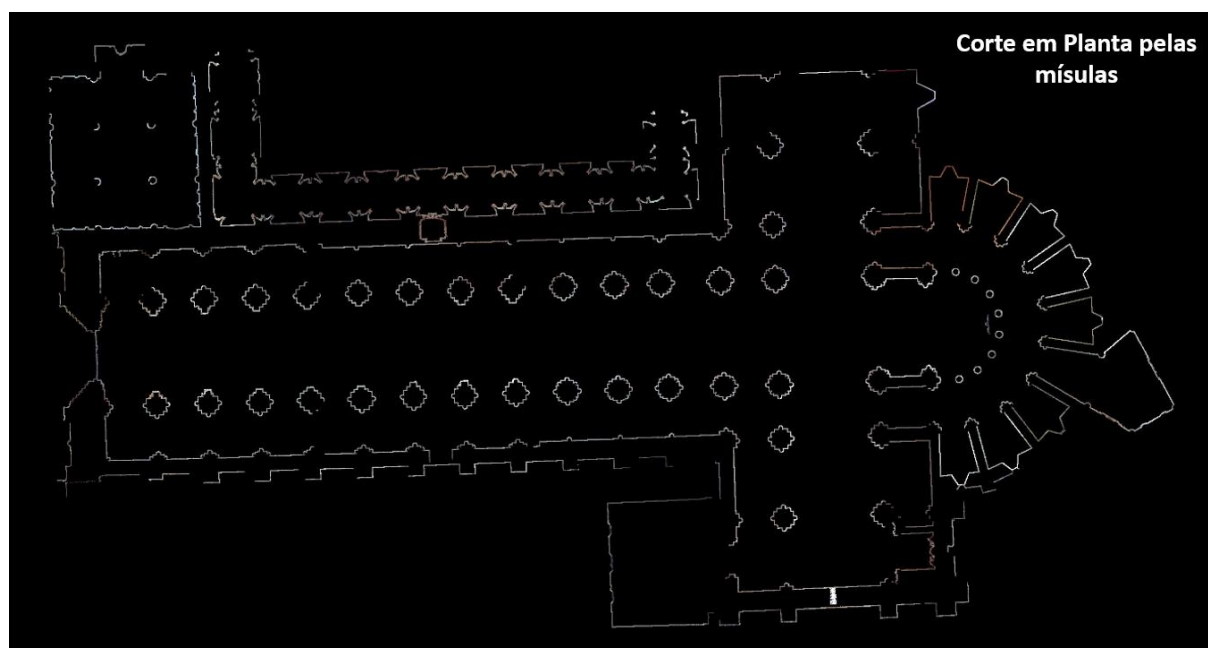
Corte em planta pela altura das mísulas piramidais dos pilares da Igreja do Mosteiro de Alcobaça.
